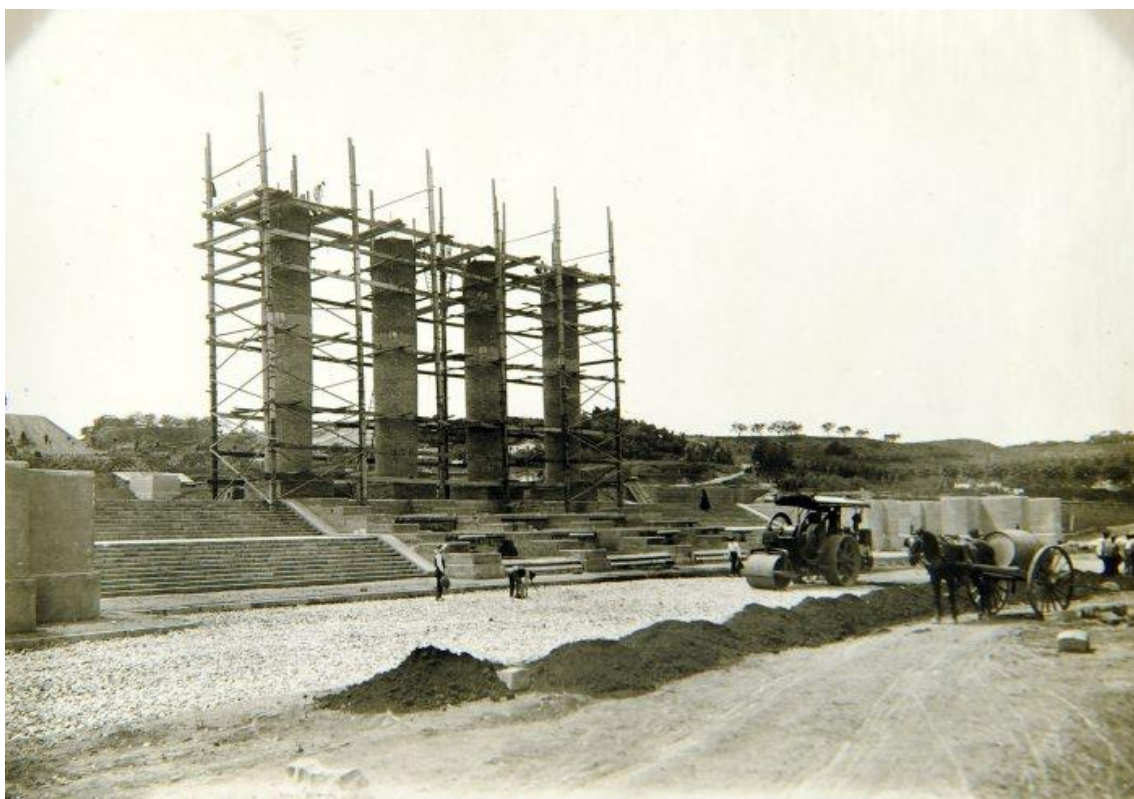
Construcción de las cuatro columnas proyectadas por Puig i Cadafalch para el conjunto de Montjuïc. Fuente: Arxiu Fotogràfic de Barcelona.
